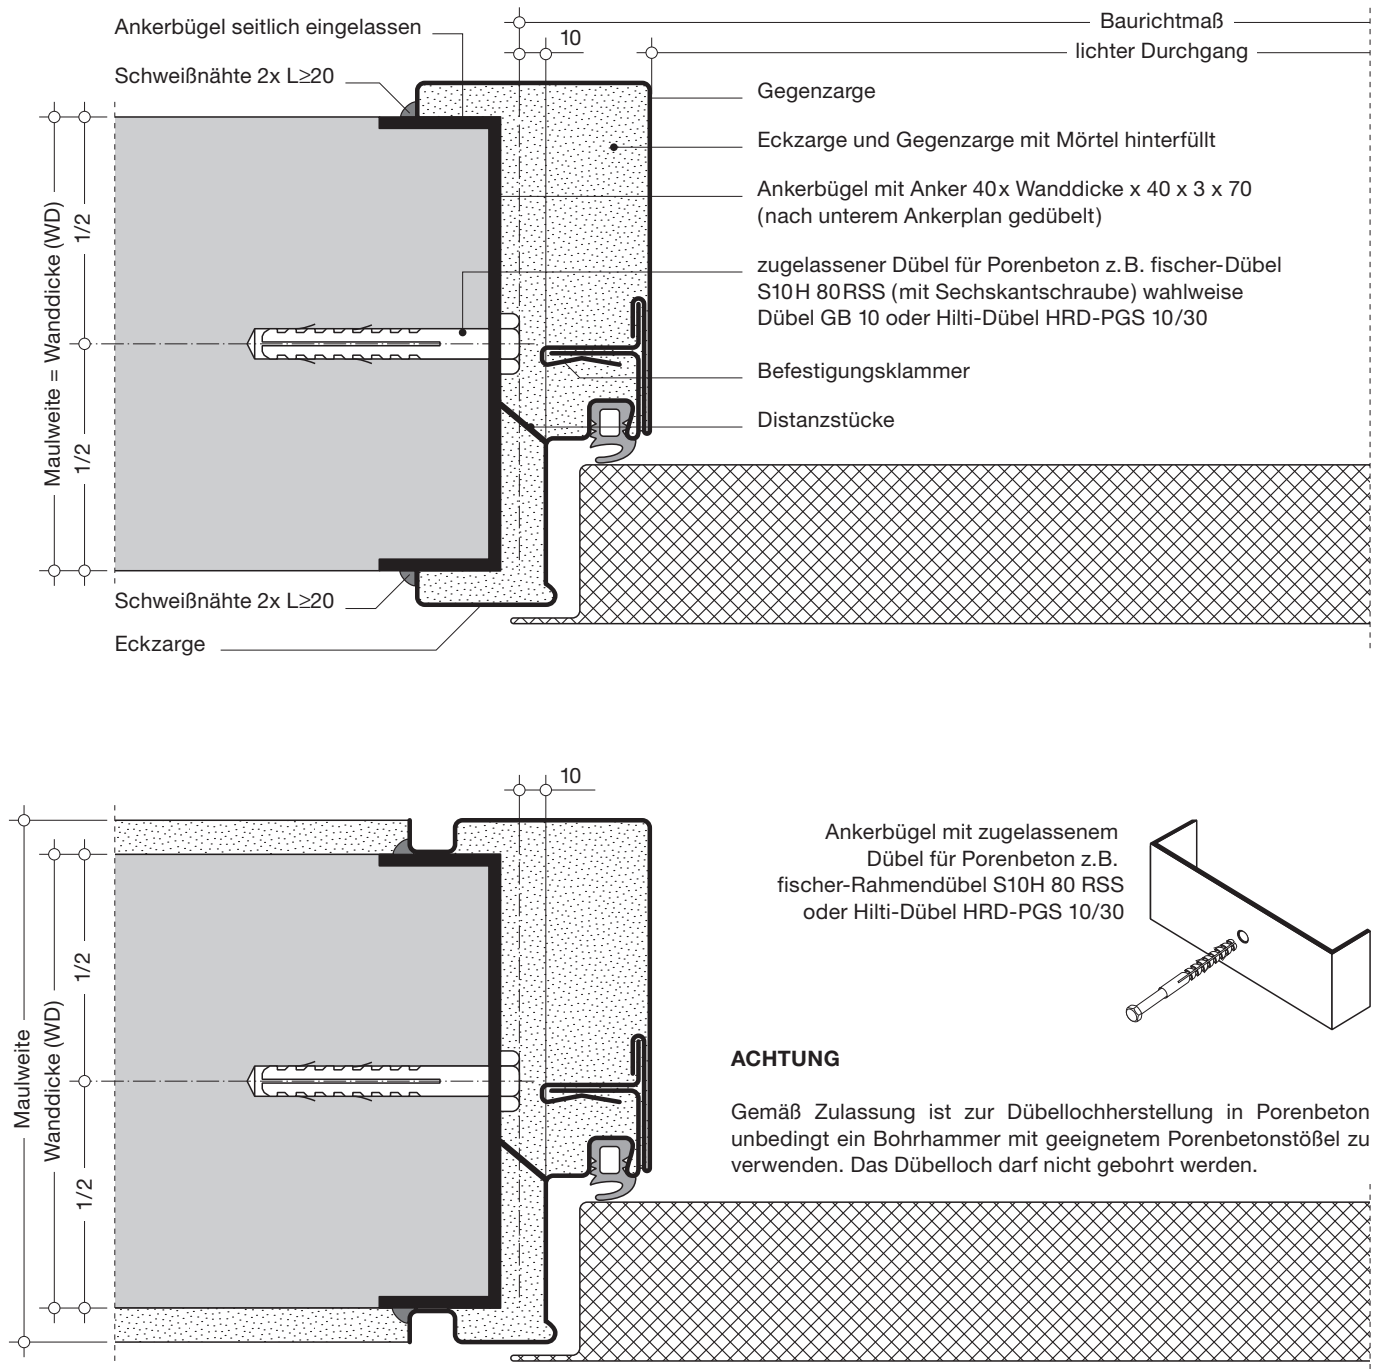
Beispielhafte Dübelmontage zur Befestigung der Zargen und Einbau einer T 90-Tür in eine Wand aus Porenbetonmauerwerk
